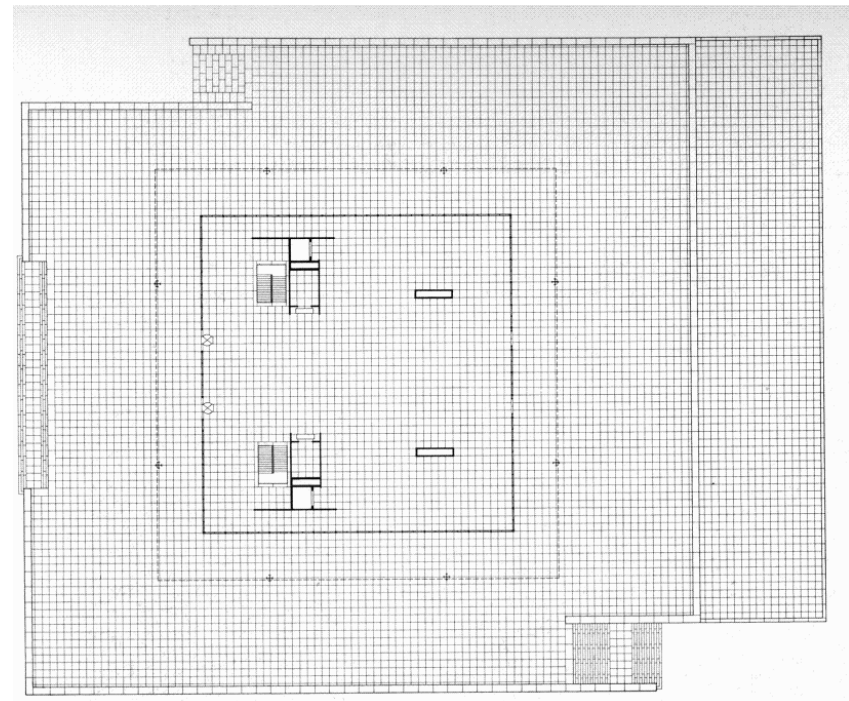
Planta do pavimento térreo, escadas, depósitos e *shafts
